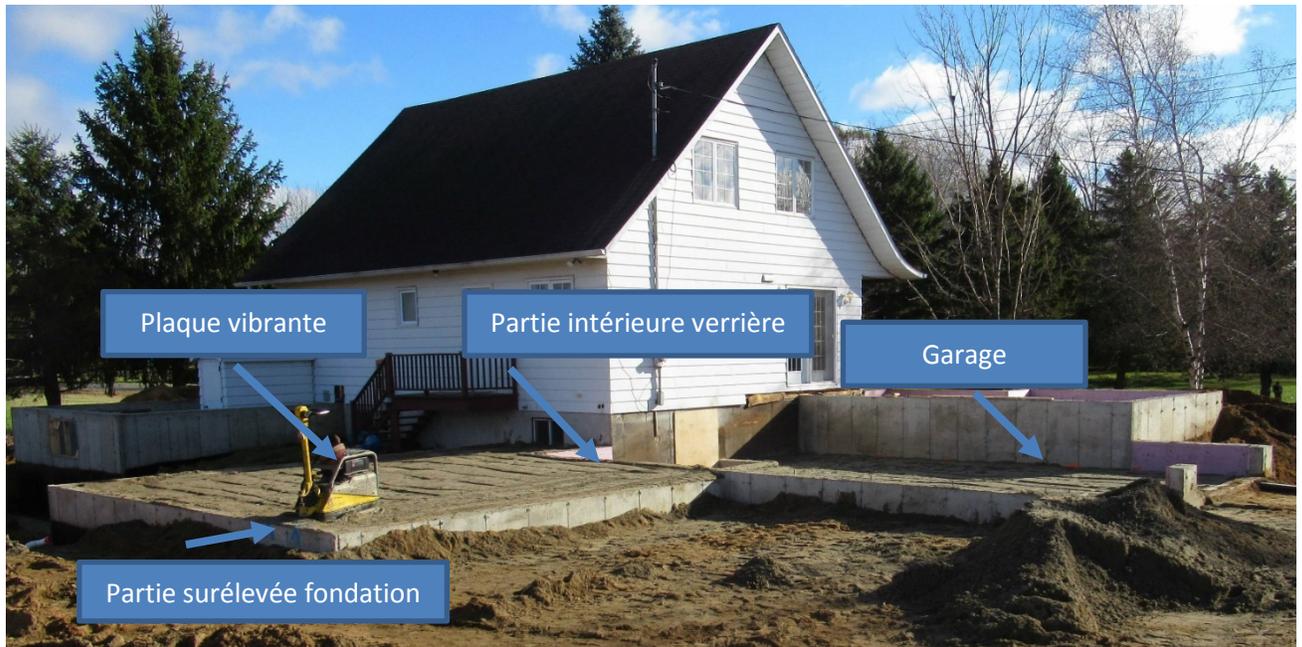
Fondations de la verrière et du garage (source : CNESST)
